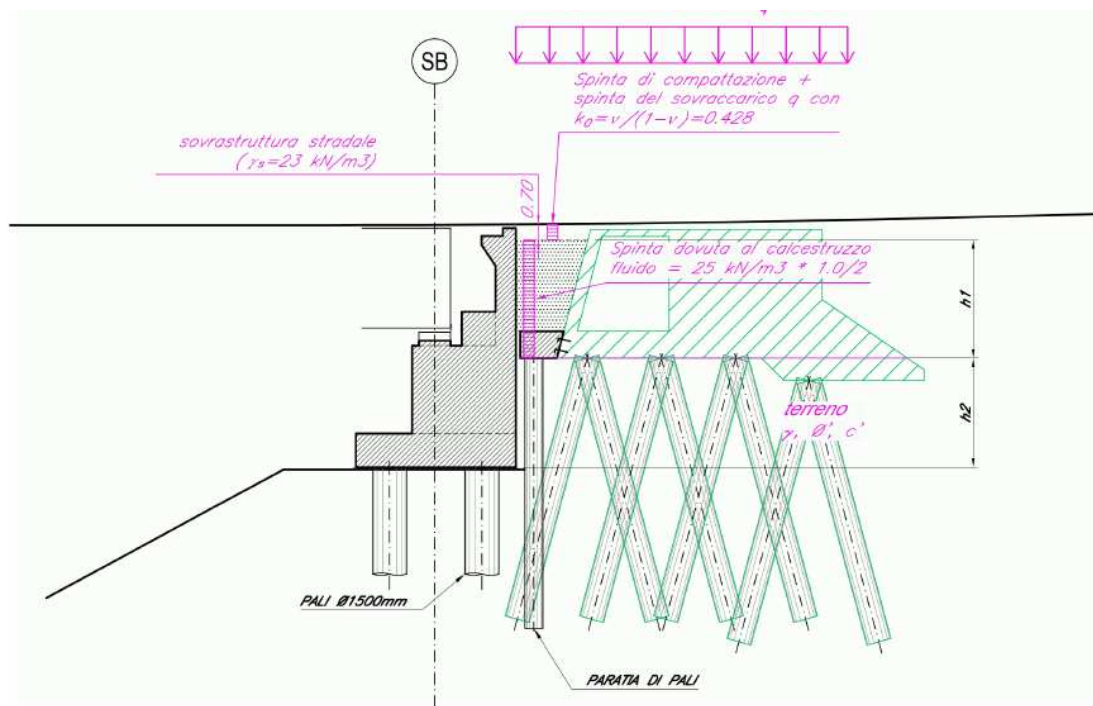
Spalla B, spinta sul paramento della spalla. Caso statico
